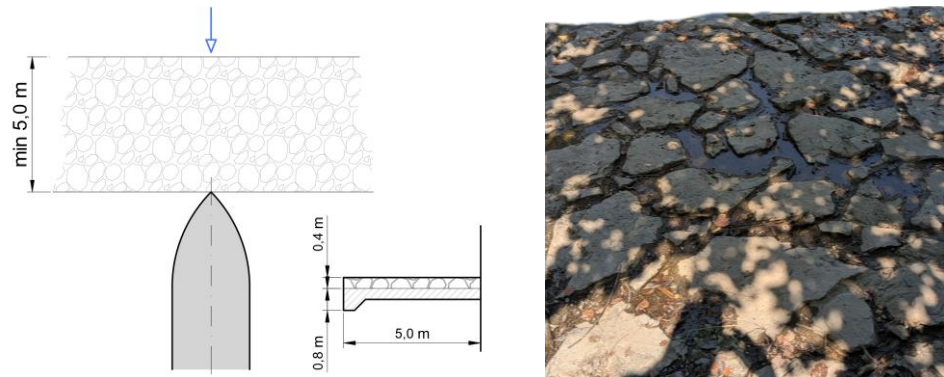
Príklad opevnenia brehu betónovými doskami (Zdroj: rieky.sk, © Plameňák)
